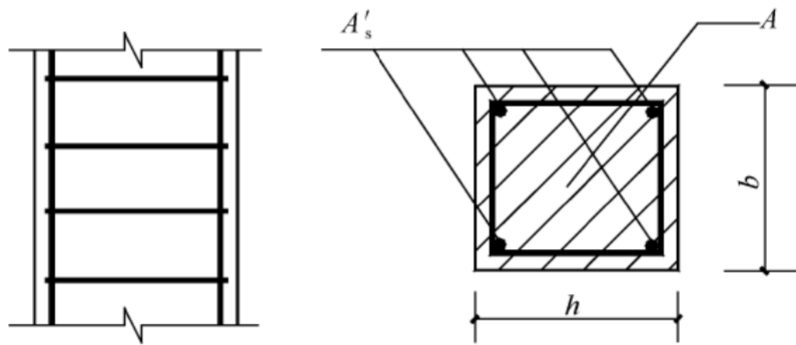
配置箍筋的钢筋混凝土轴心受压构件
